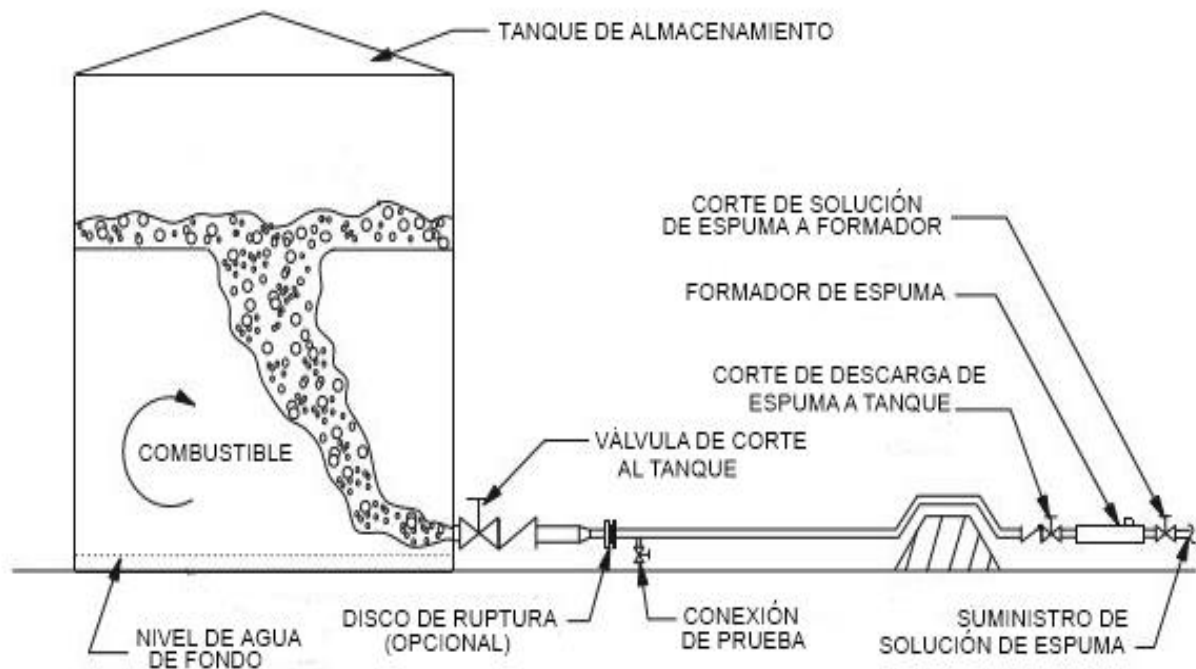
Protección sub superficial a tanques de almacenamiento de techo fijo
